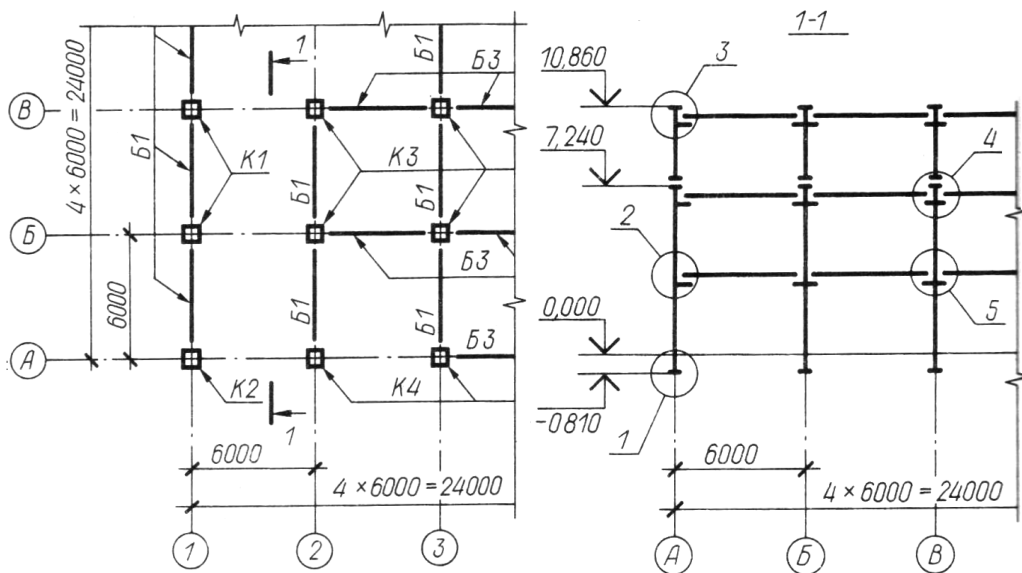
Фрагмент схеми розташування колон і балок багатоповерхової будівлі
